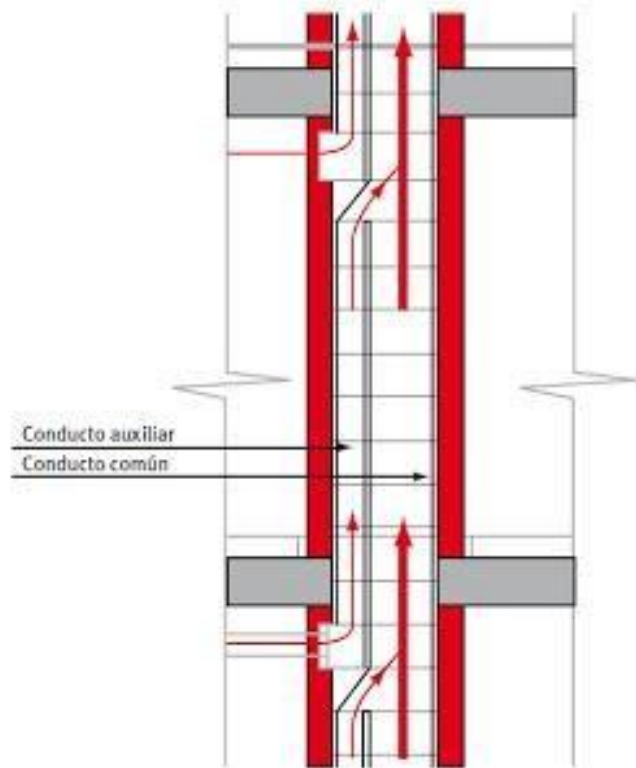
Chimenea colectiva de obra con dos conductos interiores
